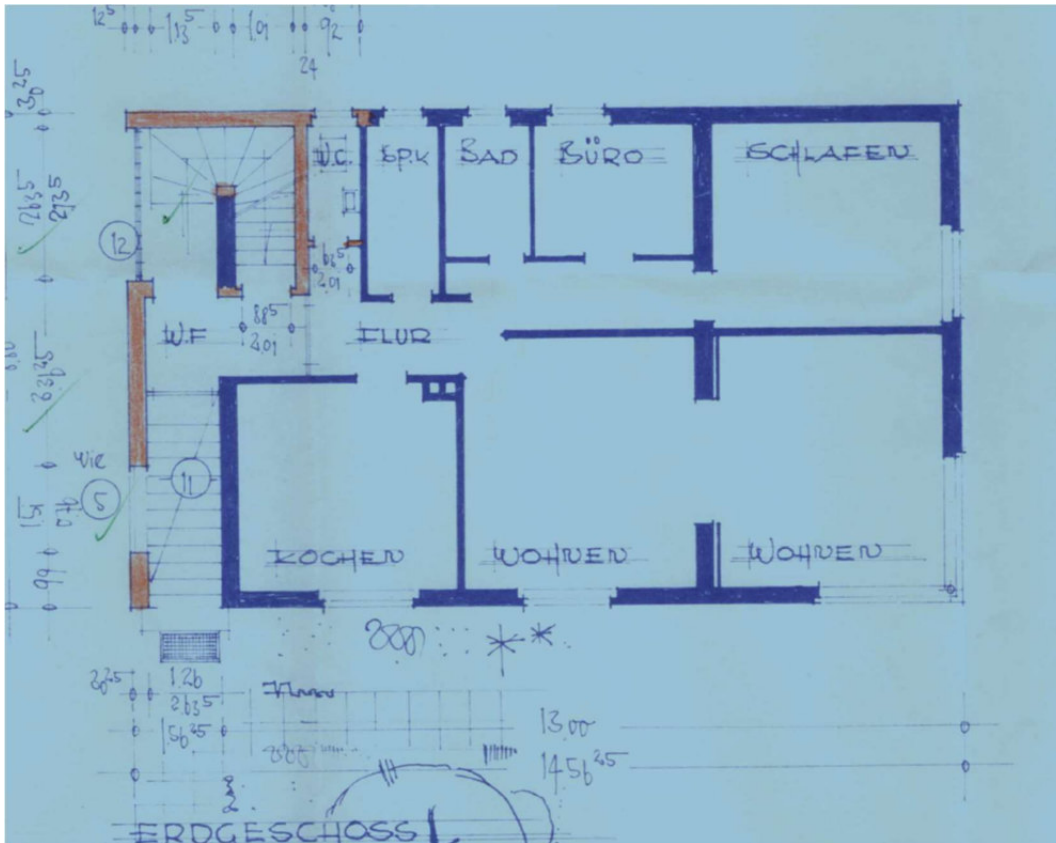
Grundriss-skizze Erdgeschoss
